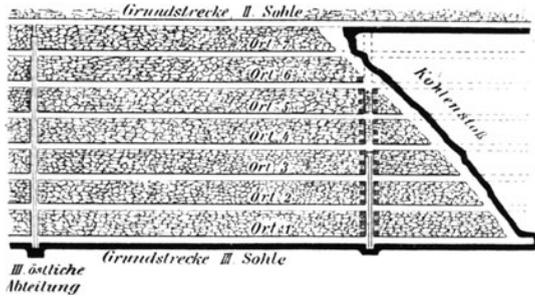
StREBBAU mit wandernden Bremsbergen.
